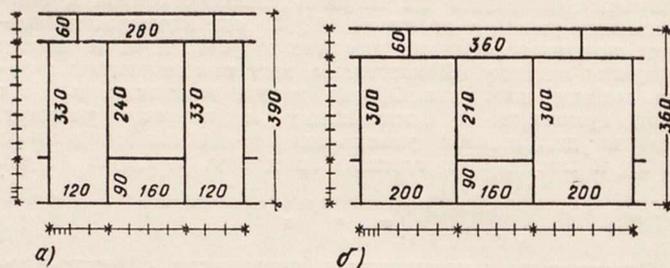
Примеры рядовых ячеек фасада крупноблочных зданий а — школа; б — больница
